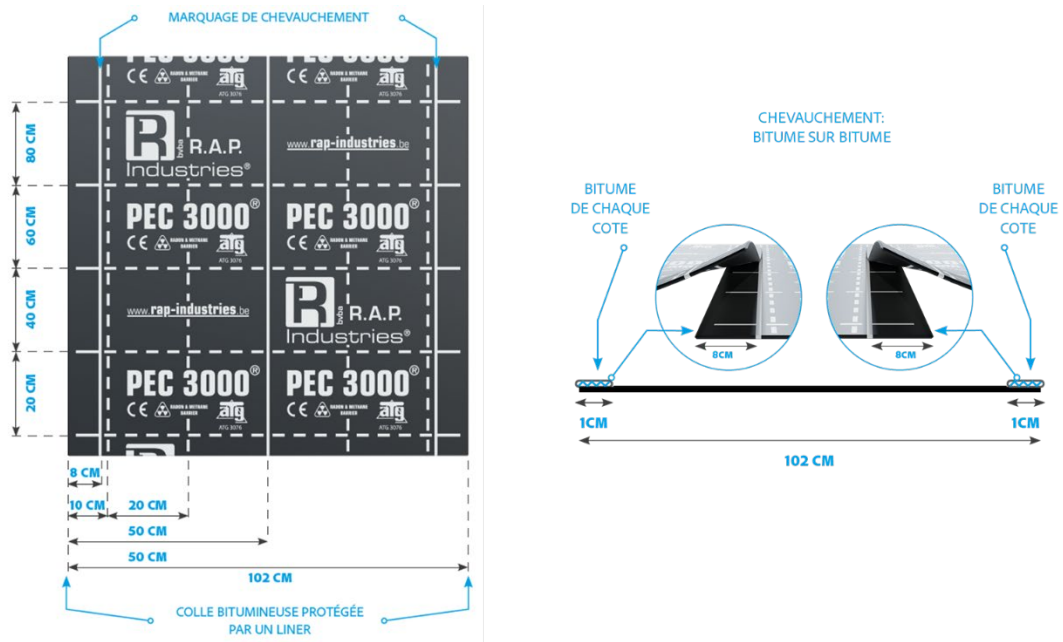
Membrane PEC 3000® et détail du recouvrement
